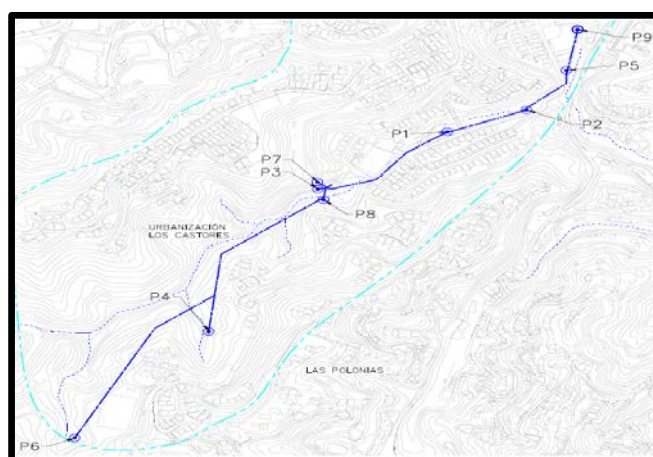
Plano de planta con la ubicación de las fuentes de abastecimiento
